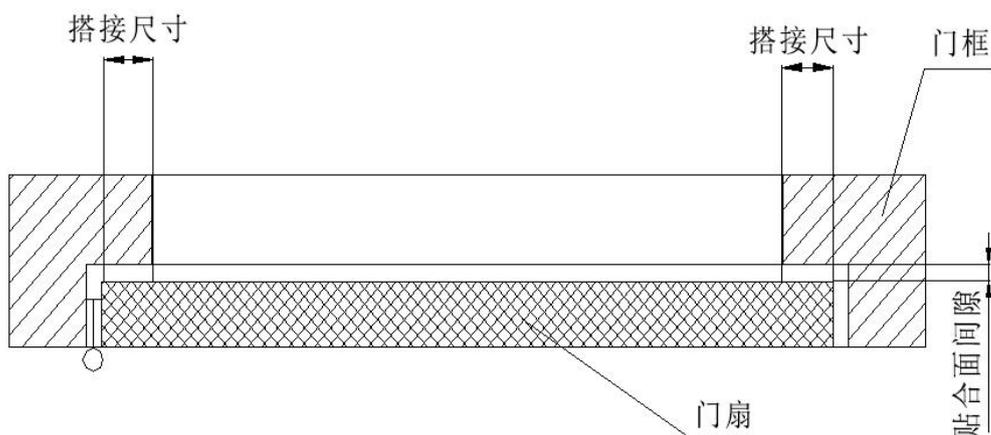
门扇与门框的搭接尺寸和贴合面间隙示意图
